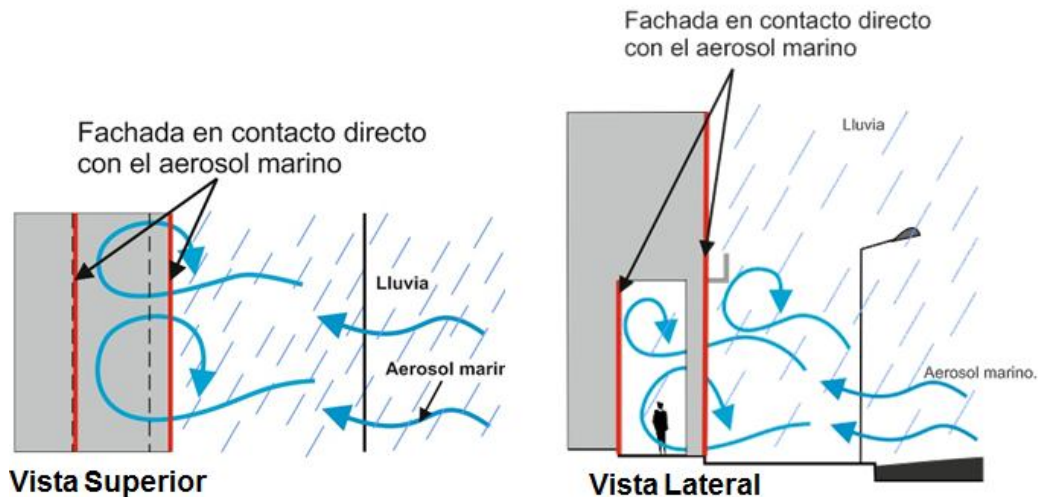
Efecto de no apantallamiento en las fachadas del Malecón Tradicional. Fuente: Autores.
